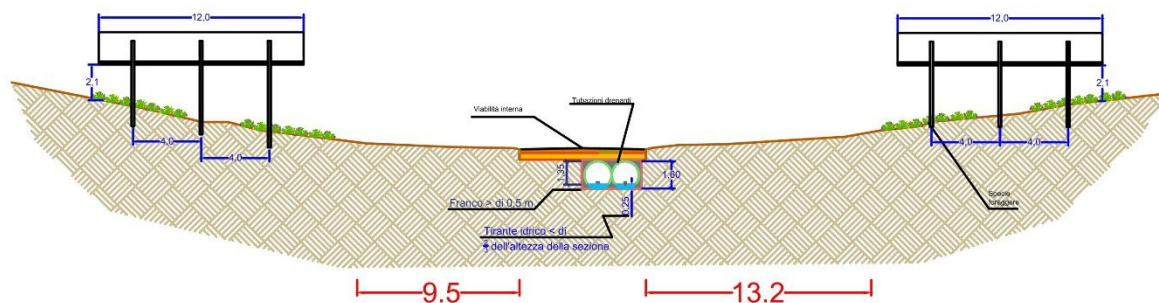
Attraversamento corso d’acqua localizzato all’interno dell’"Area C" con la viabilità interna di nuova realizzazione e indicazione posizione tubazioni drenanti a sezione circolare di nuova realizzazione – estratto dell’elaborato di progetto "Tav.34 Inquadramento su CTR ante e post operam su bacini idrografici"
